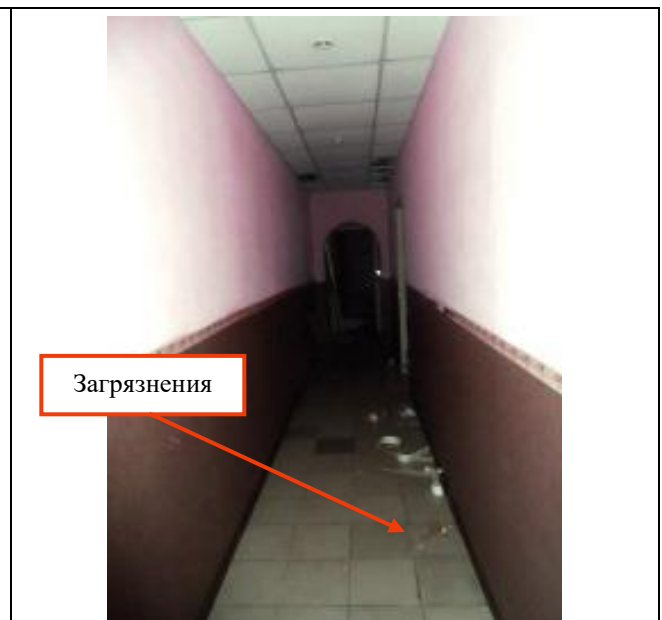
Часть помещения №4 помещения 6-Н, вид в сторону помещения №3
